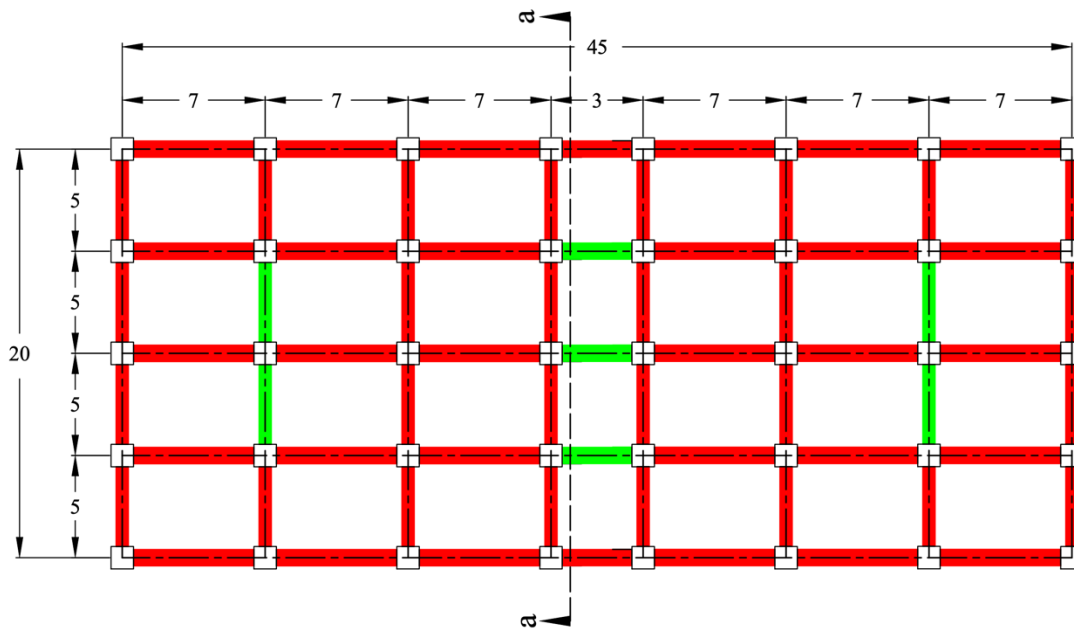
Plano estructural de planta de edificación base de diseño; trabes estructurales con carga muerta debido al peso de muros de carga, resaltadas en color rojo y trabes con carga muerta debido al peso de muros divisorios de mampostería, representadas en color verde; corte “a” ubicado en la sección longitudinal de la edificación. Dimensiones en m. Creación propia.
